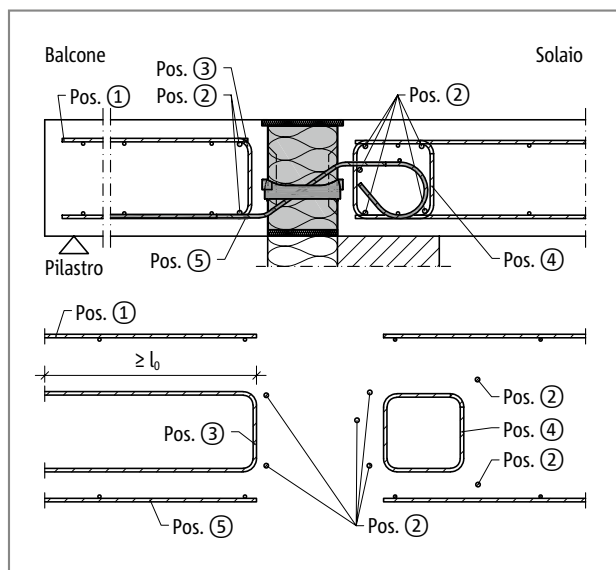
Schöck Isokorb® XT tipo QL-V1 a V4: armatura in opera
